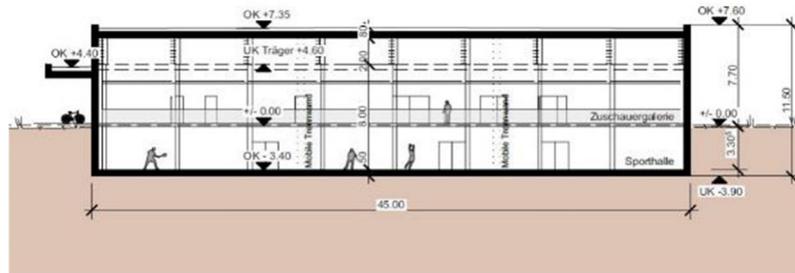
„versenkte“ Doppelsporthalle B | Disposition 1 - Längsschnitt
